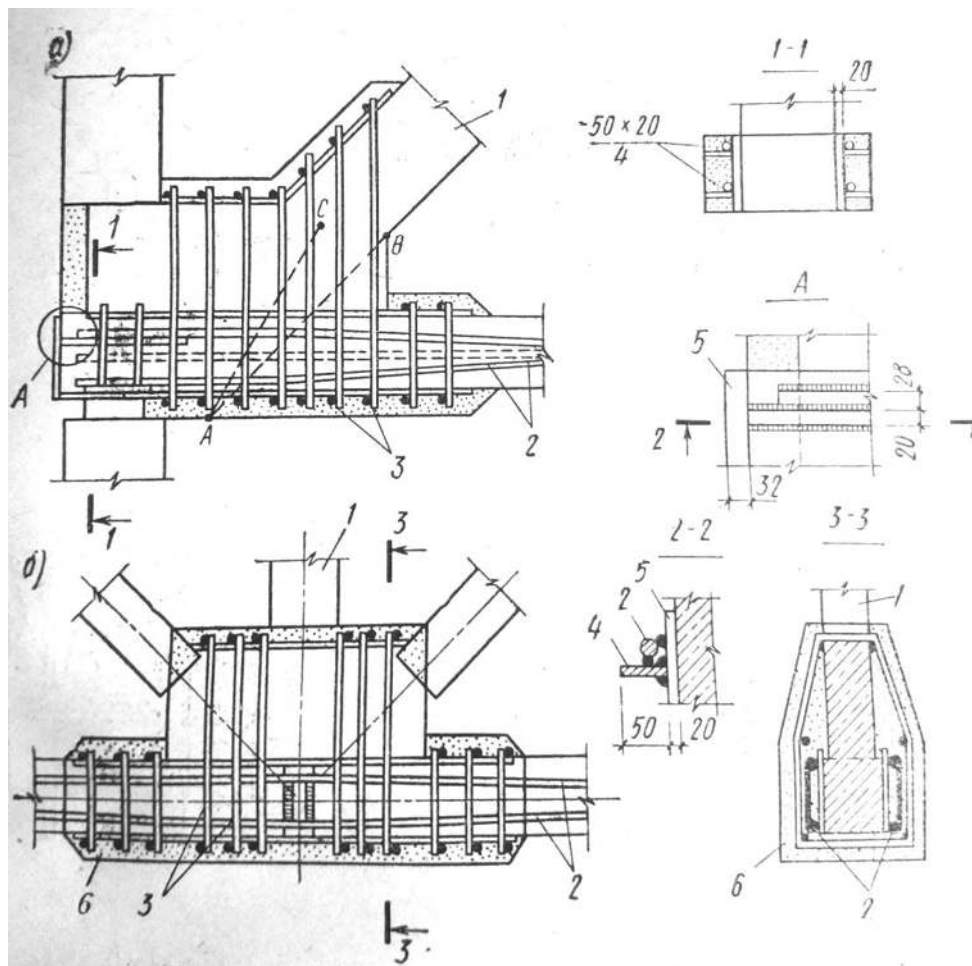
Усиление нижнего пояса и узлов стропильной фермы:
